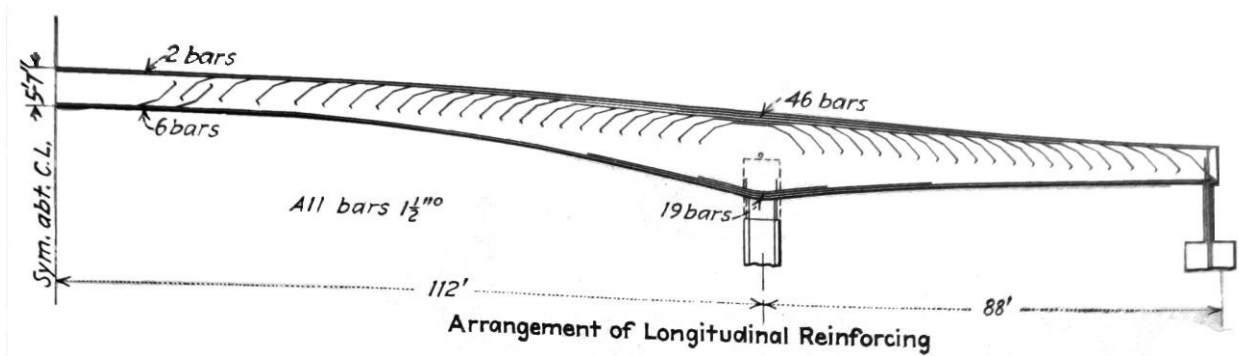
Disposição longitudinal da armadura nas vigas principais. FONTE: SCHJÖDT, 1930.
